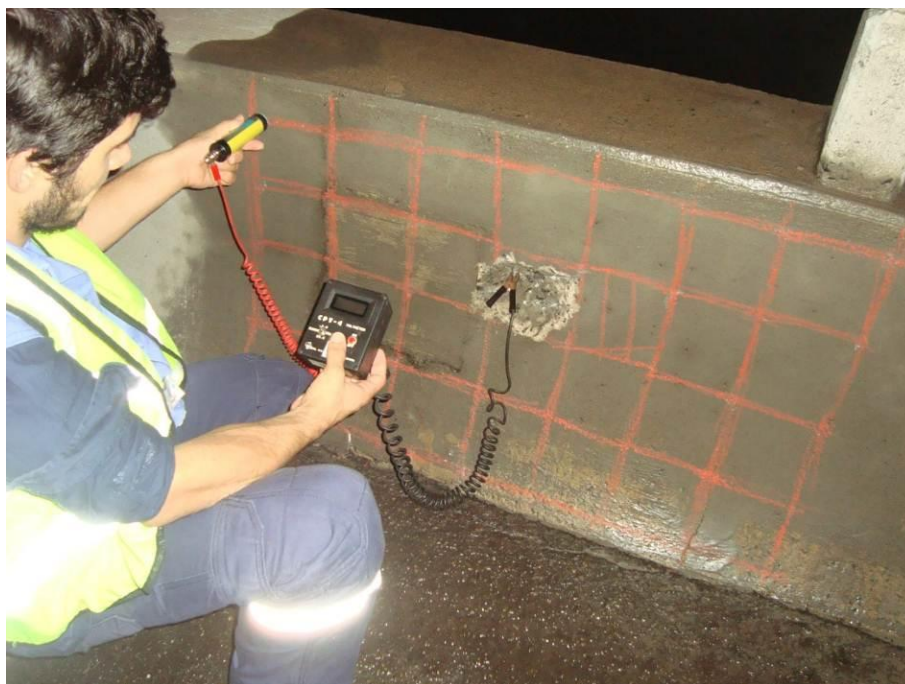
Local escolhido para o ensaio II, sobre reparo executado anteriormente (aproximadamente 5 anos).
